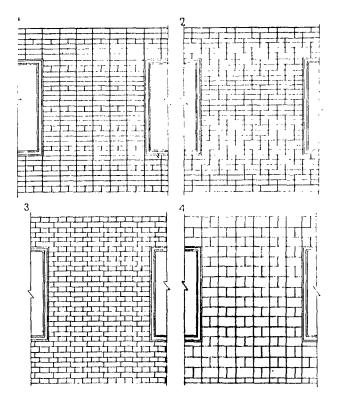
Примеры декоратнаной облицовочной кладки фасадиых стен
